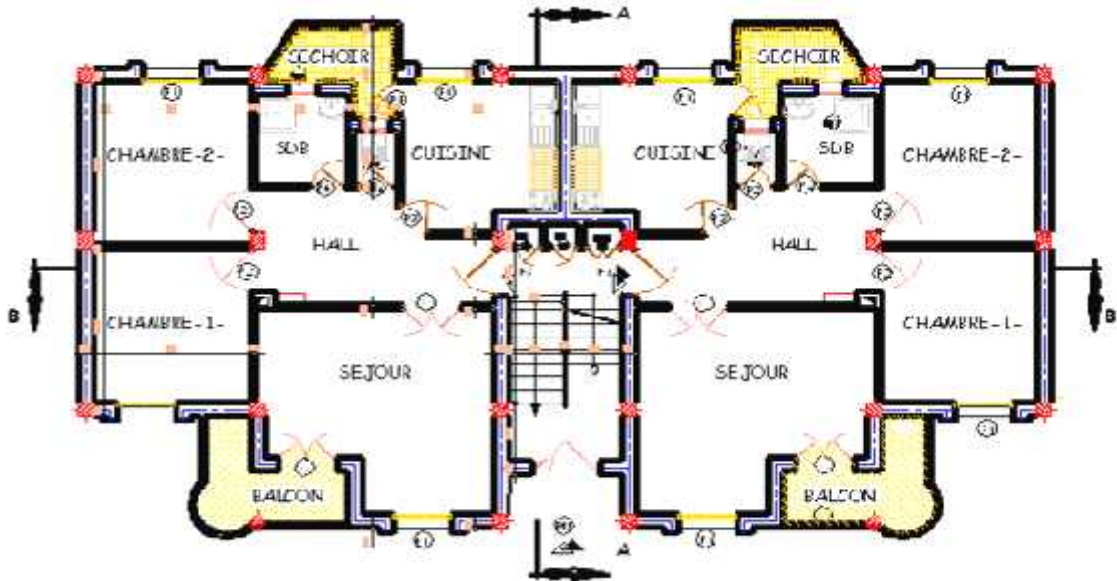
Plan RDC bâtiment barre type F3 du 3eme cas d'étude (Source: bureau d'étude)
